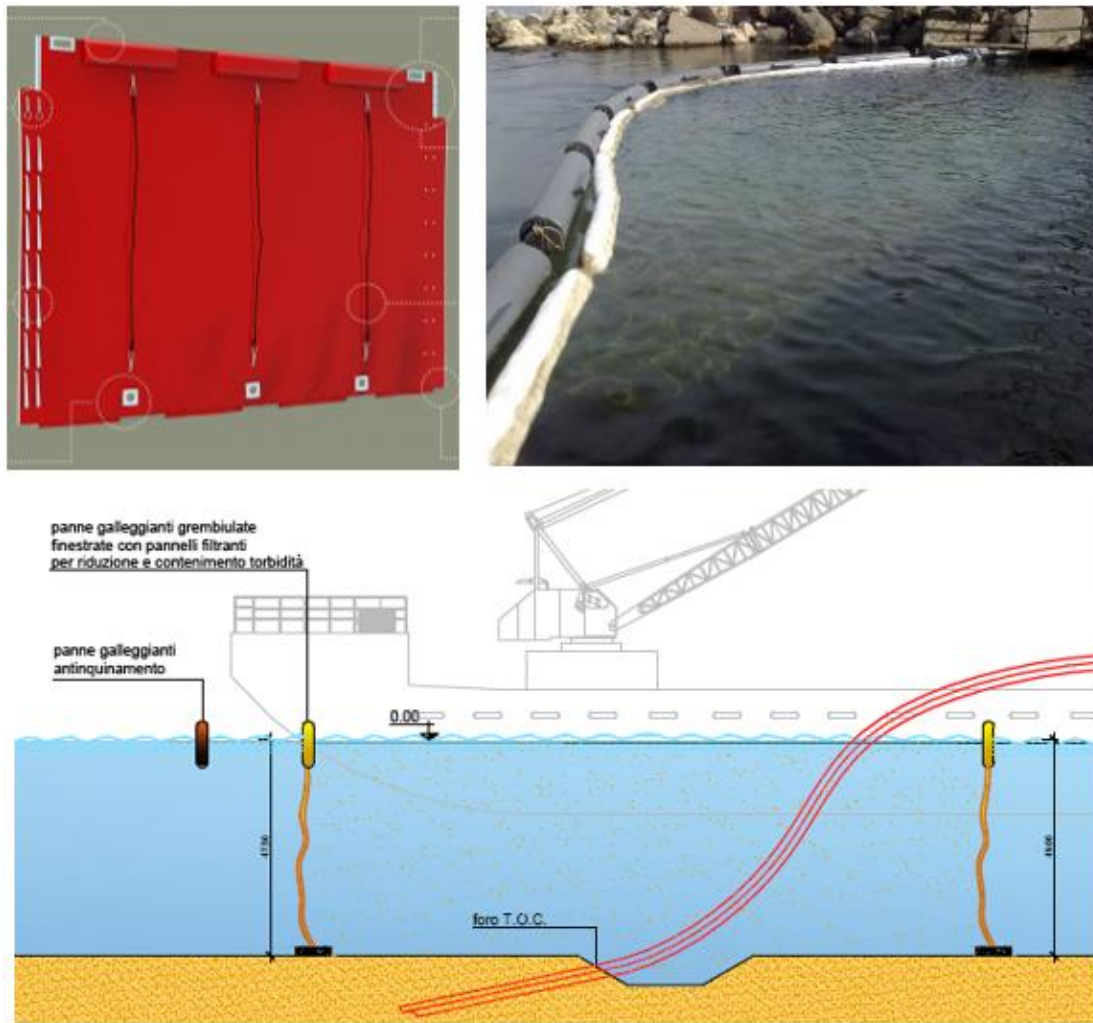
Esempio sistemi di protezione contro torbidità e sversamenti a mare
